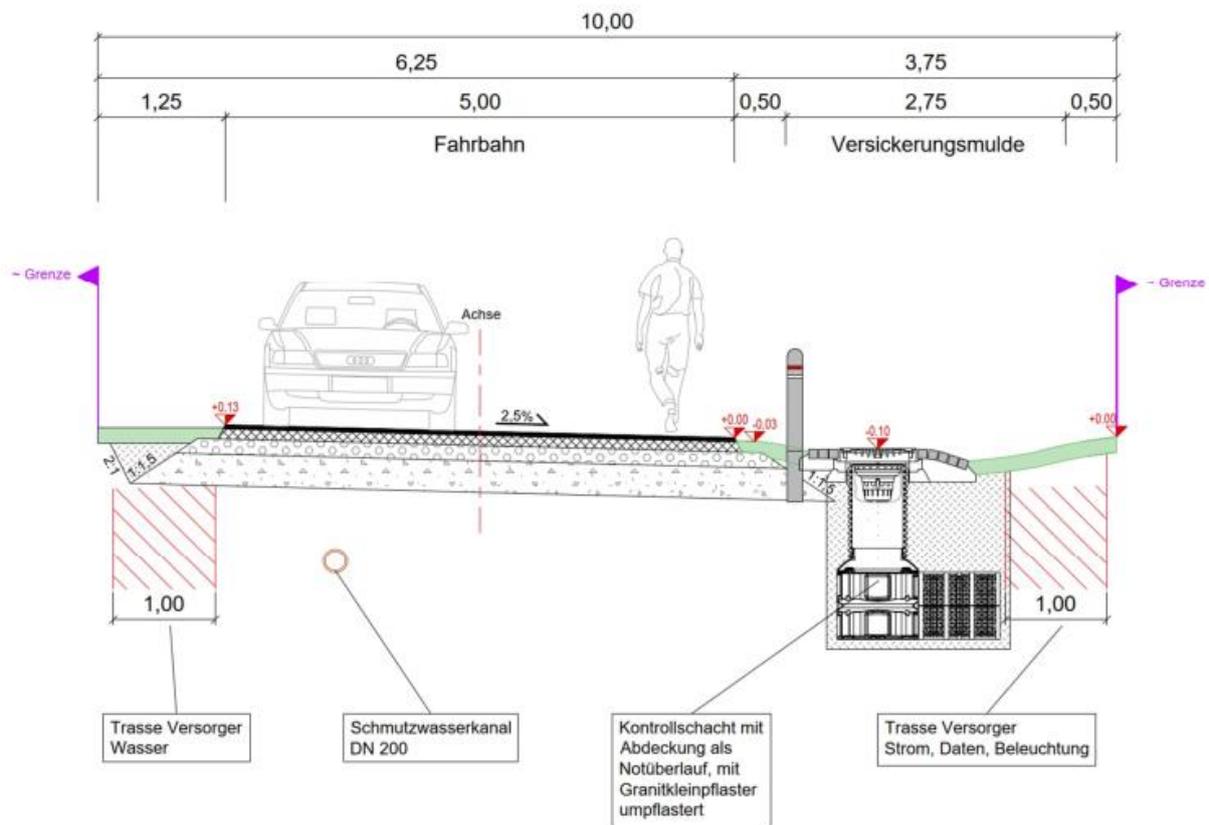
aktuelle Planung zum vorgesehenen Regelquerschnitt der Planstraße (o.M.),
